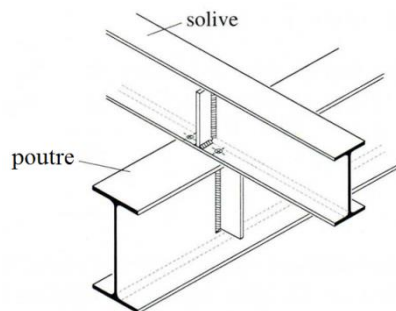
Assemblage d'une solive continue sur une poutre principale
